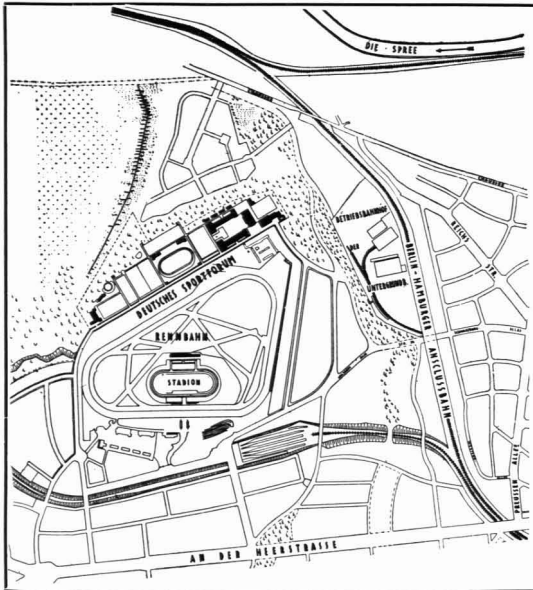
Lageplan der Grunewaldrennbahn mit Stadion und Sportforum 1928
